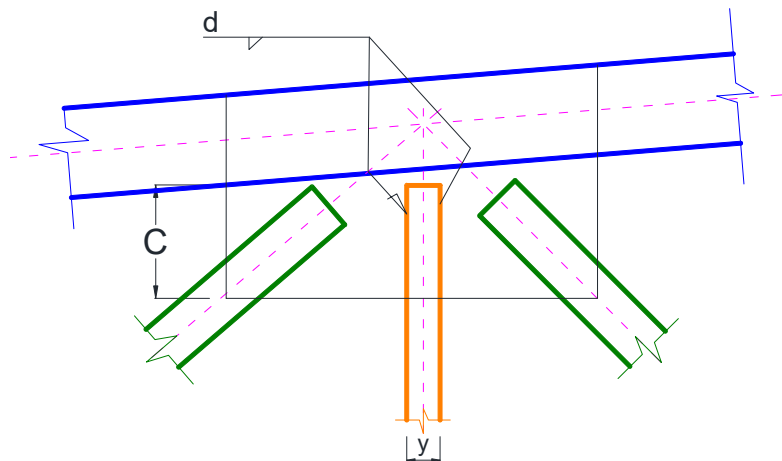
Diagrama de Soldadura en Montante
